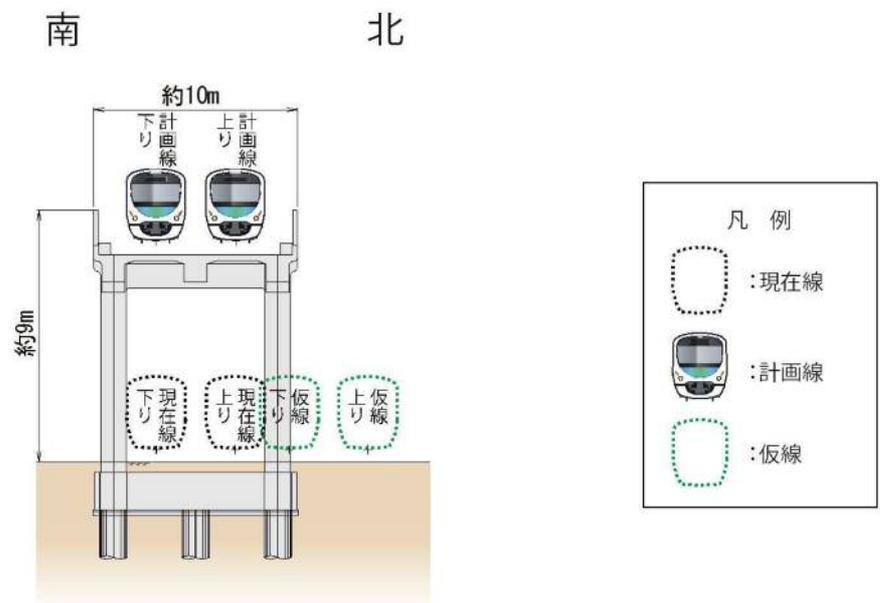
(1) 一般部 (F-F' 断面：高架橋) 標準断面図
